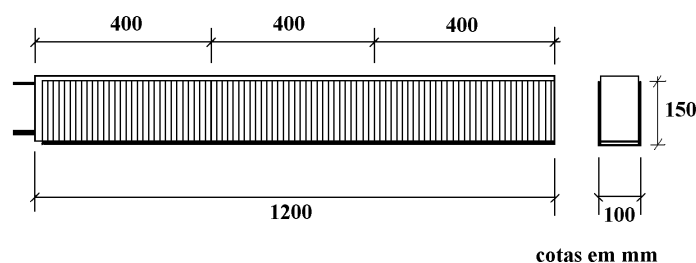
Vigas Reforçadas Ensaaiadas por SOUDKI e SHERWOOD (2000)
